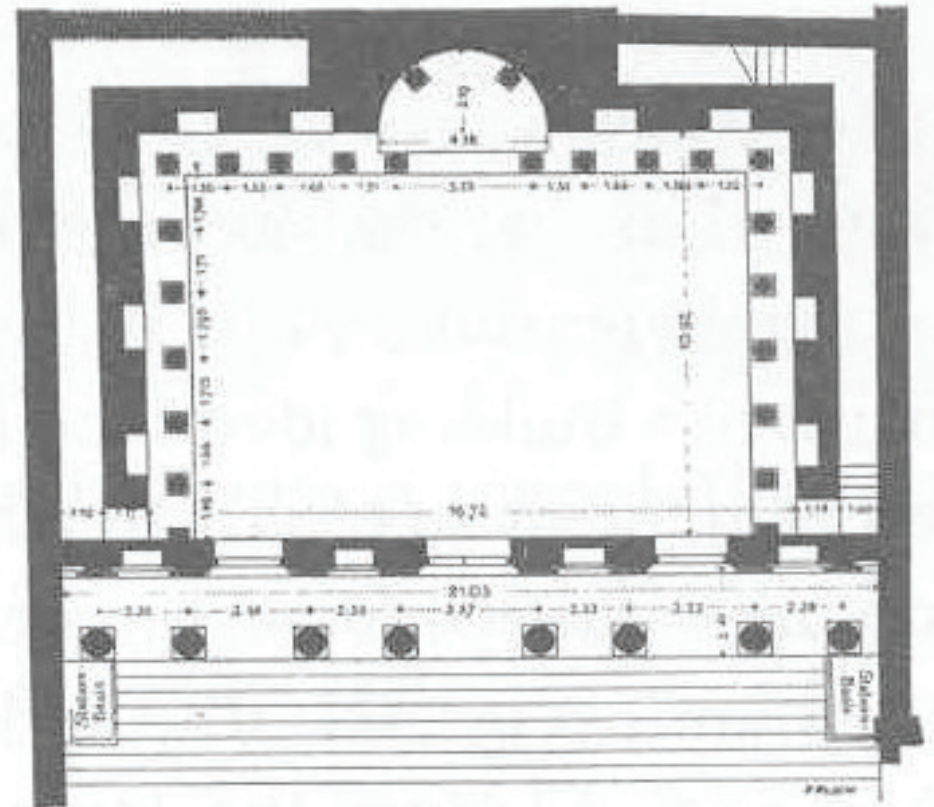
Grundriss der Bibliothek in Ephesos, errichtet 109 n.Ch.
